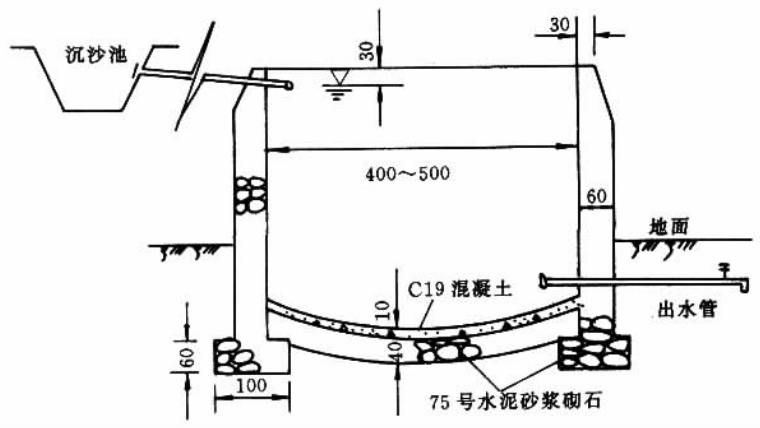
开敞式圆形蓄水池立面图(单位:cm)
